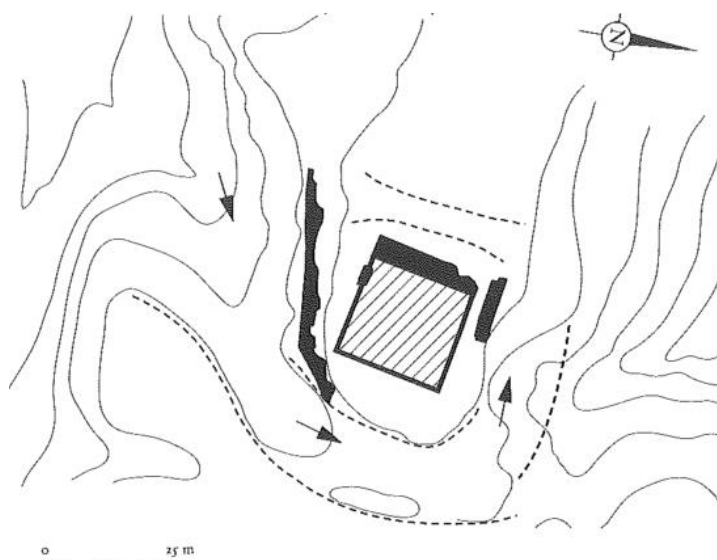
Planta hipotética de la torre de Los Castellazos (Romeo 2002: 172).
